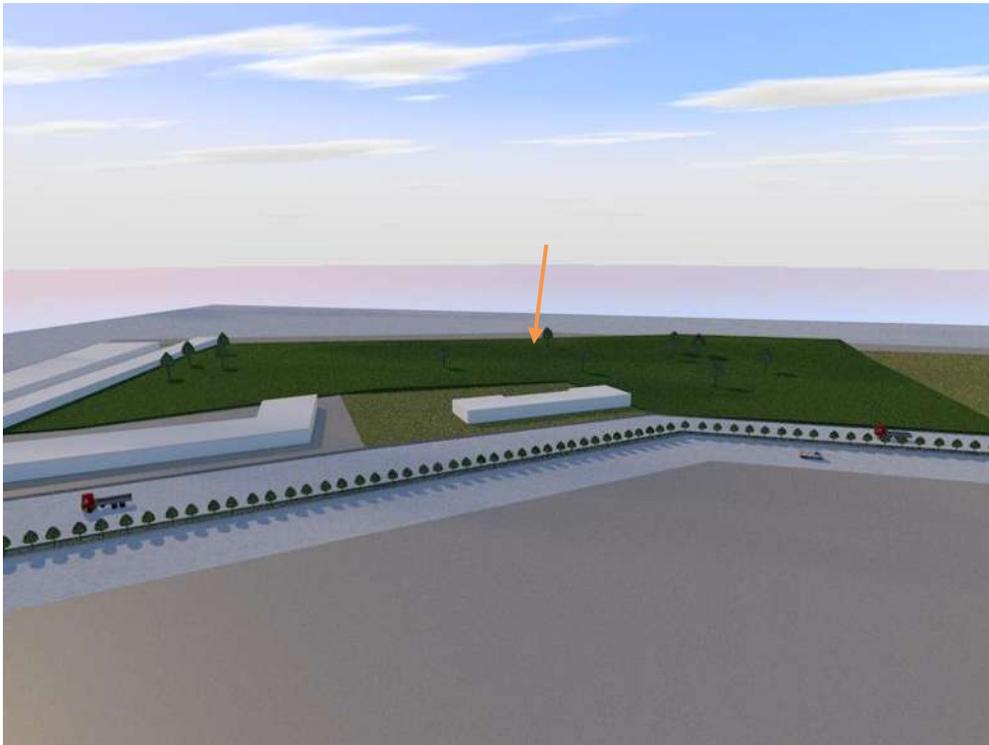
Vista Este. Autor: Cynthia Alvarado
